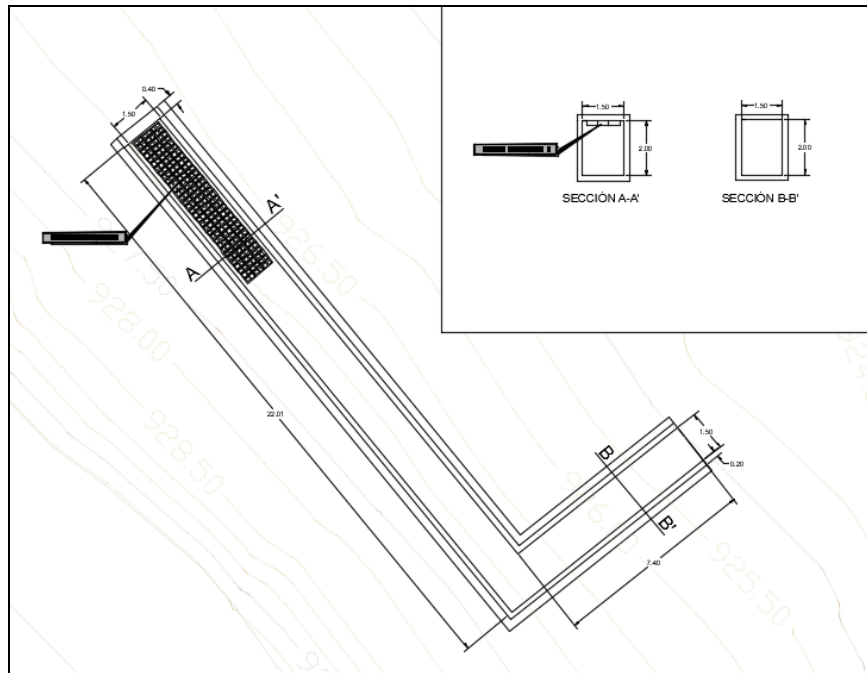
Galería de nueva construcción. Alternativa 2
